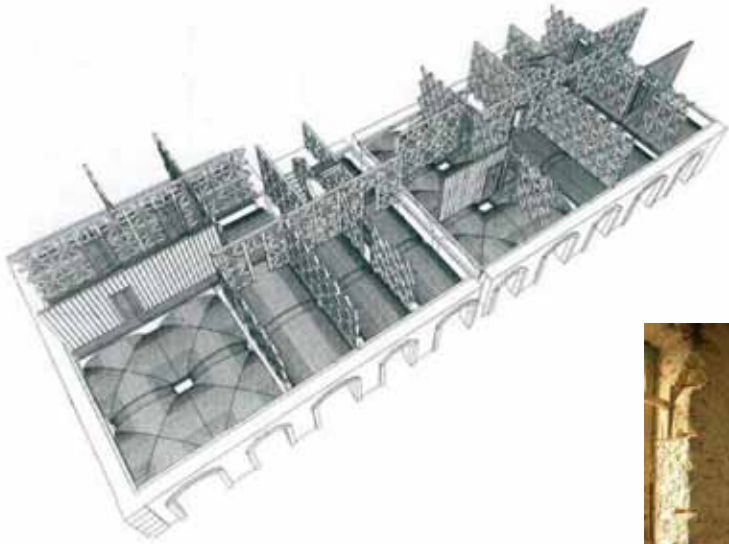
ª. Modelo 3D del primer piso sobre muros y columnas de planta de calle. No se dibuja el suelo para apreciar las bóvedas. Silva 2007.
